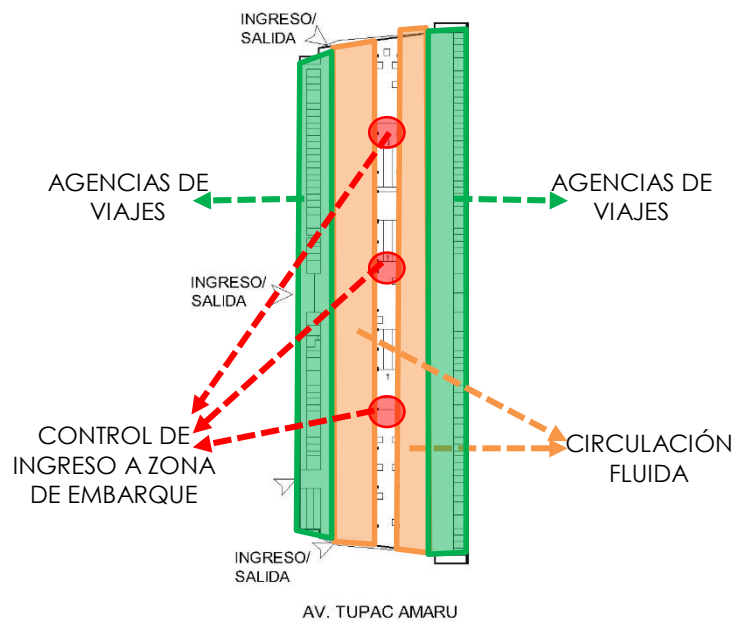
Vista en Planta Primer Nivel Terminal Terrestre Plaza Norte
